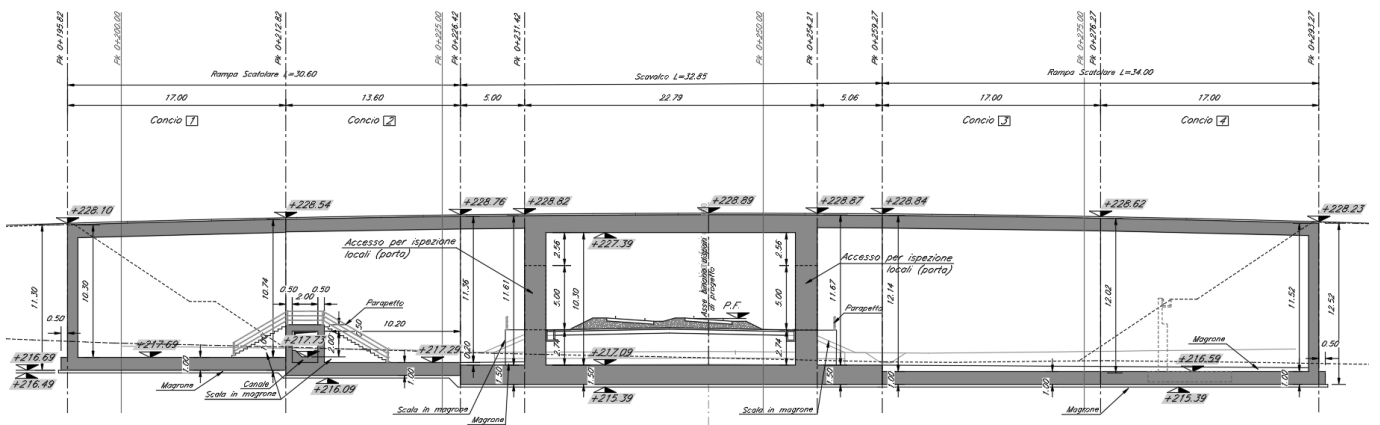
Sezione longitudinale – Rampa lato Trieste
